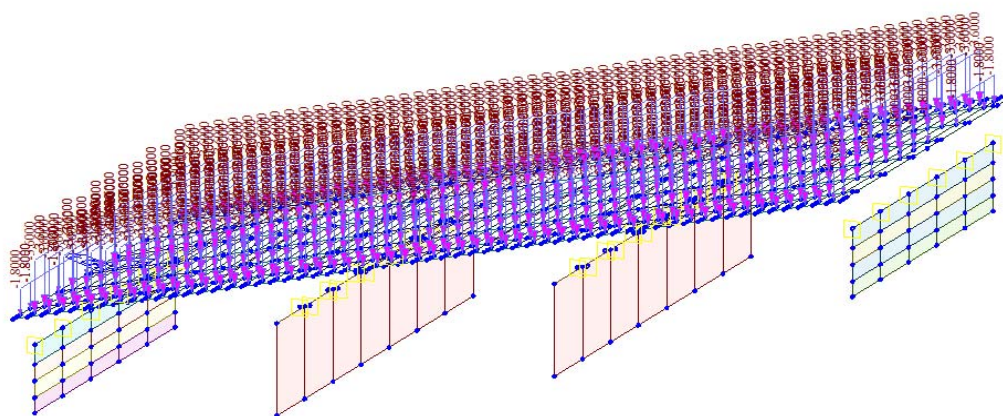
Il peso della massicciata e della pavimentazione stradale
